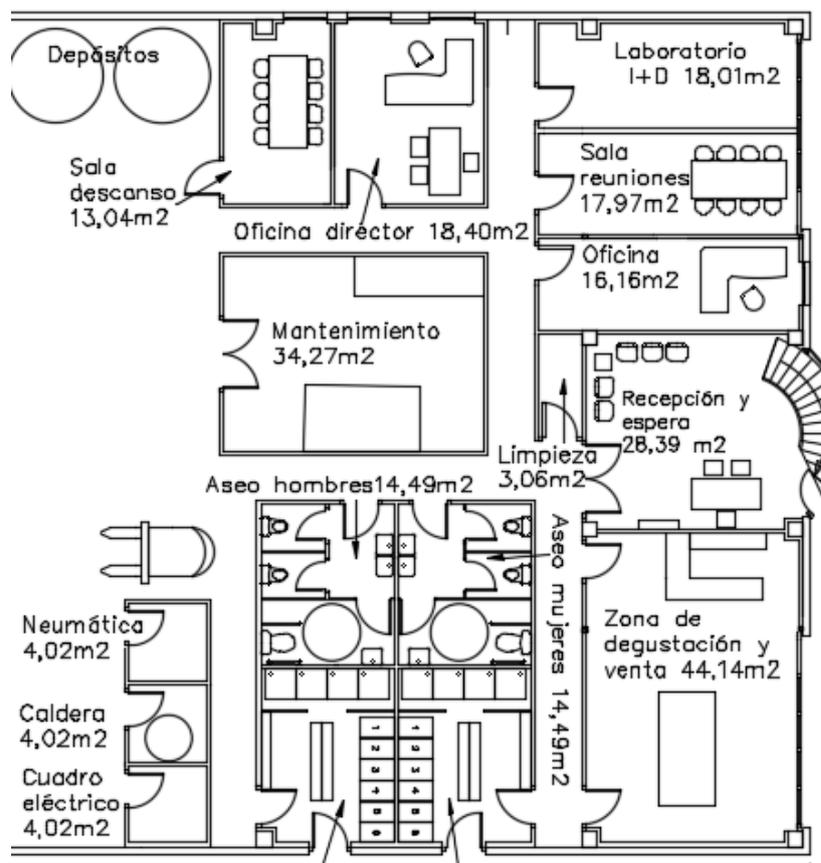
Zona de oficinas de la nave. Fuente: Elaboración propia
